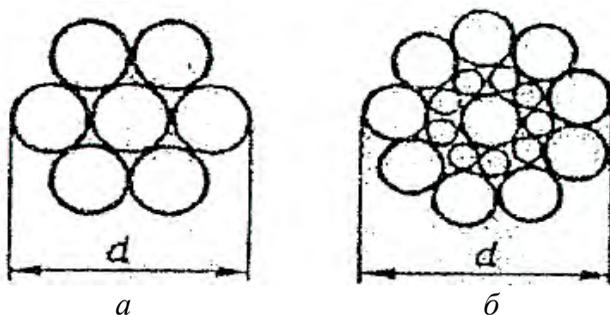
Схема поперечного сечения стальных арматурных канатов: а – К-7; б – К-19
